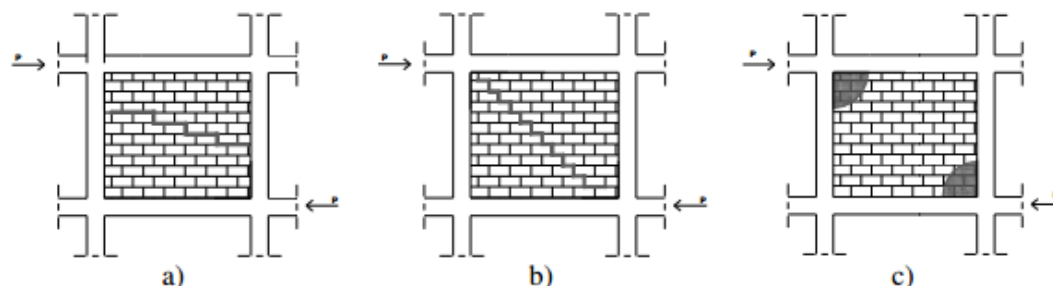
Mecanismo de rotura de painéis de alvenaria: a) rotura ao longo das juntas; b) rotura diagonal; c) rotura por esmagamento dos cantos comprimidos
